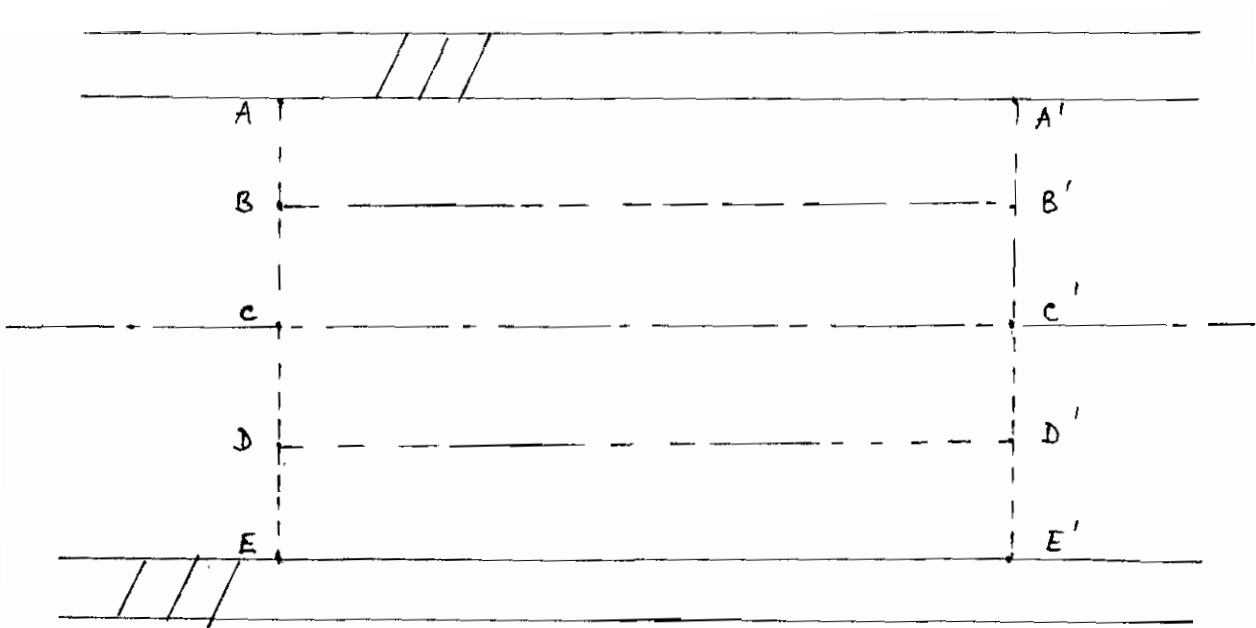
Schéma montrant la division de la chaussée en bandes rectangulaires
